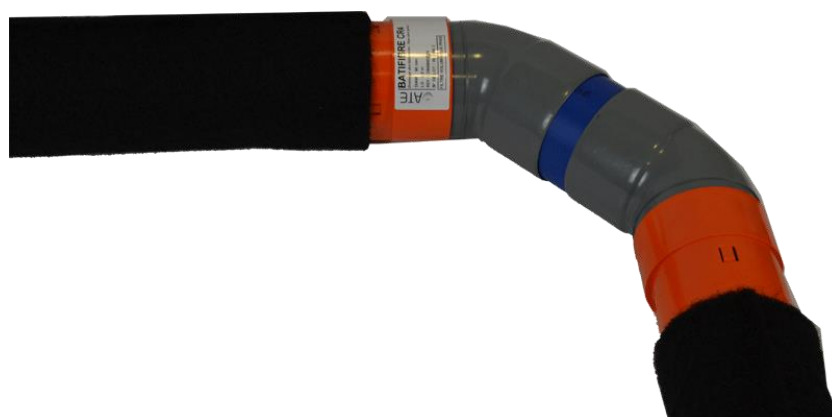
AUTRE POSITIONNEMENT POSSIBLE DE LA MANCHETTE LORS D'UN CHANGEMENT DE DIRECTION A 90°
